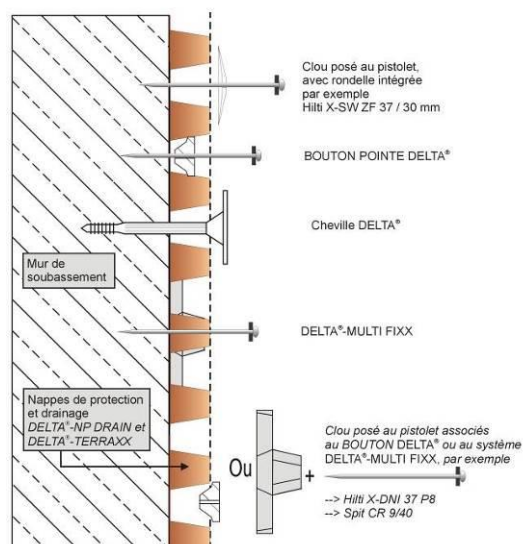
Procédés de fixation de la nappe de protection et drainage DELTA®-MS DRAIN sans revêtement d'étanchéité
